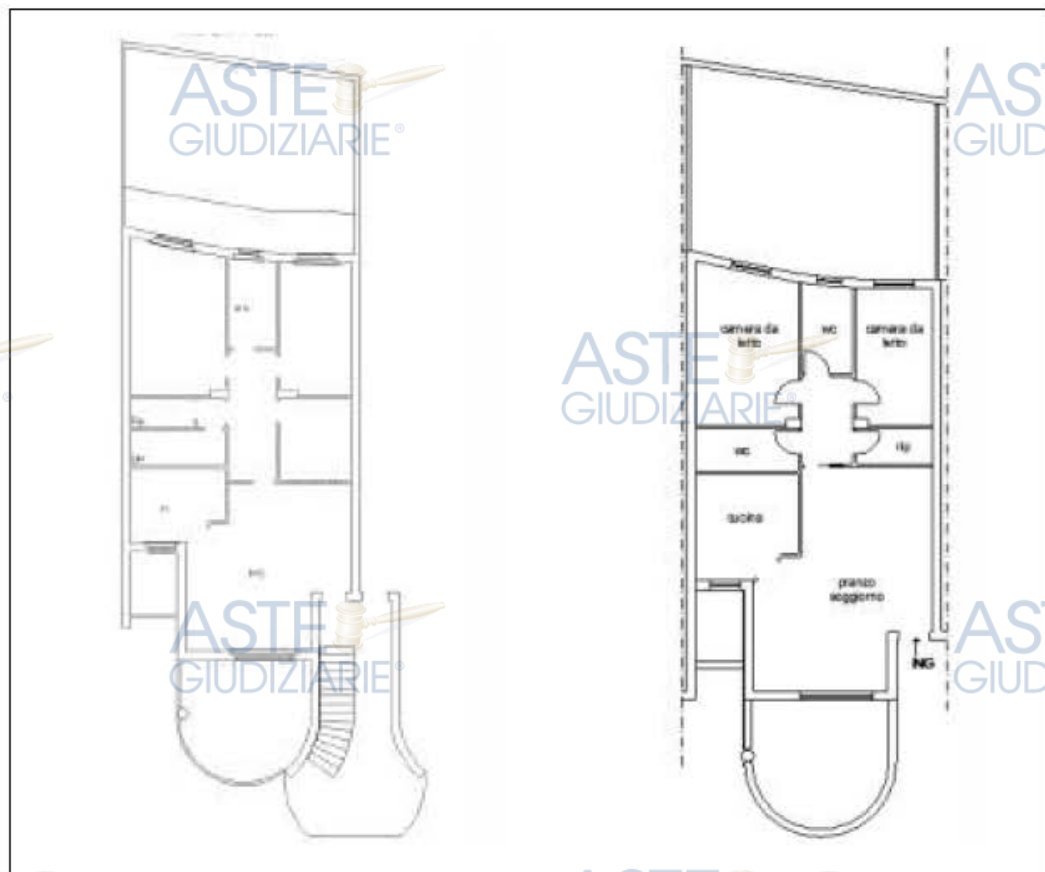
Planimetria catastale dell'appartamento sub 44 e rilievo stato di fatto
